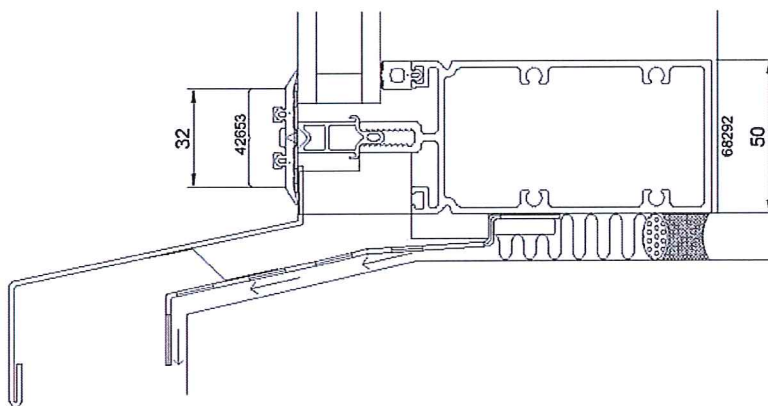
Prinsippskisse som viser glasstaksprofil med overgang mot tak hvor vinkelen er tilnærmet 90 grader. Kilde: Sapa Building System.
